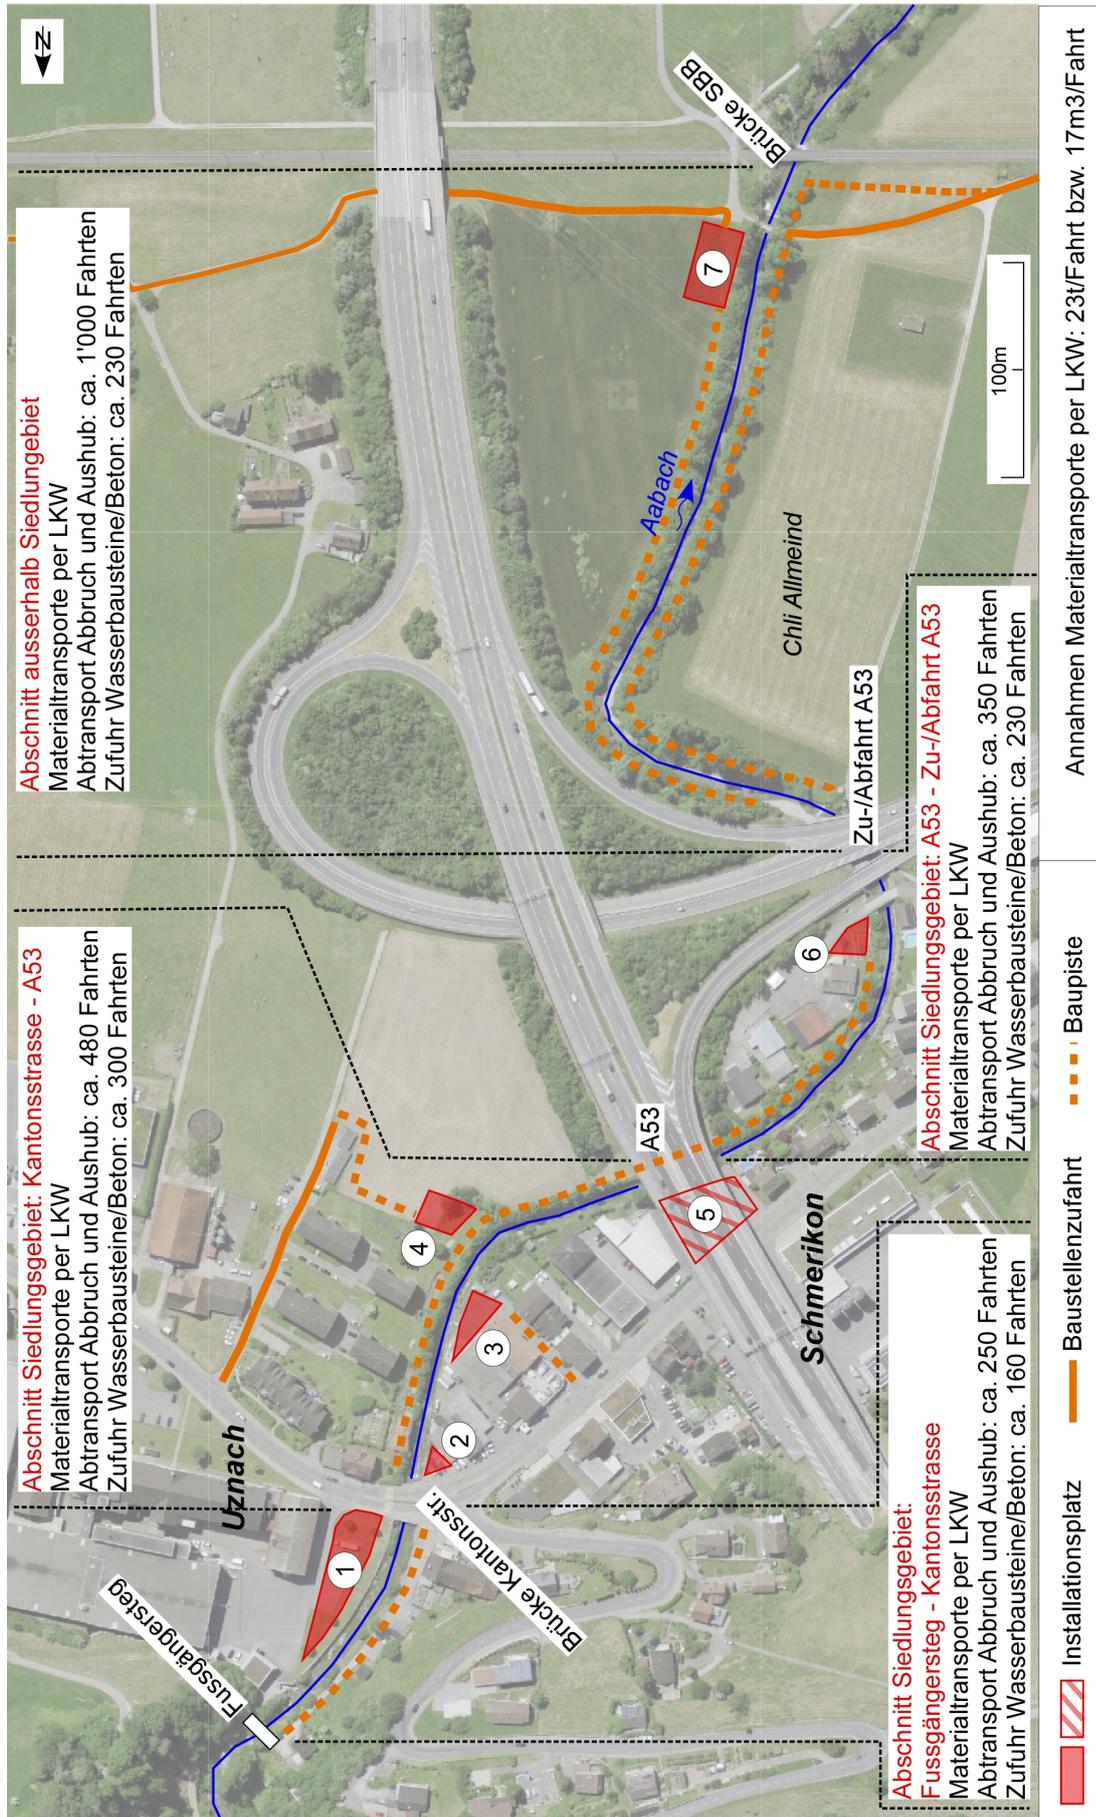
Situation mit Installationsplätzen, Baustellenzufahrten und Baupisten.
